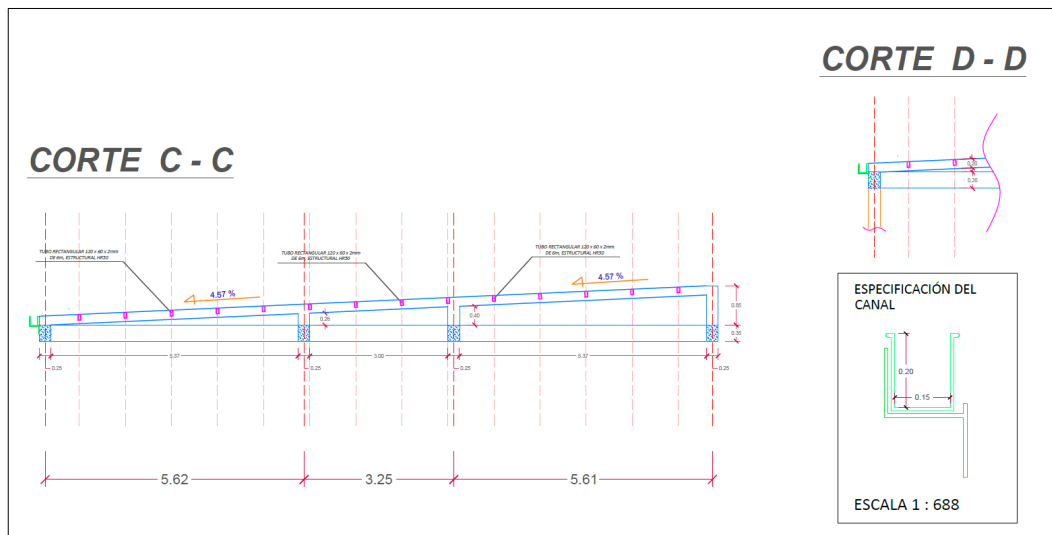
Corte arquitectónico C-C y D-D, de la estructura 1 del Centro Vida.
